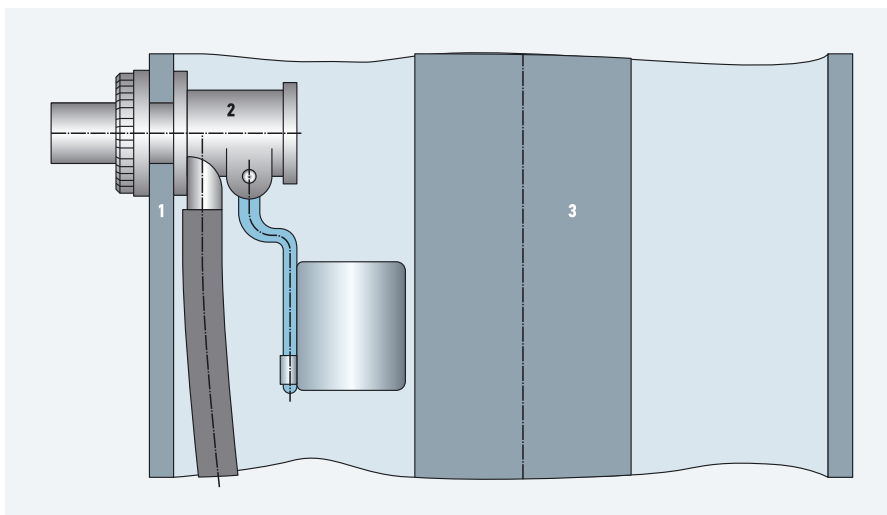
Размещение наполнительной арматуры между боковой стенкой бачка и спускной арматурой (1 — корпус бачка; 2 — наполнительная арматура; 3 — контуры спускной арматуры)
